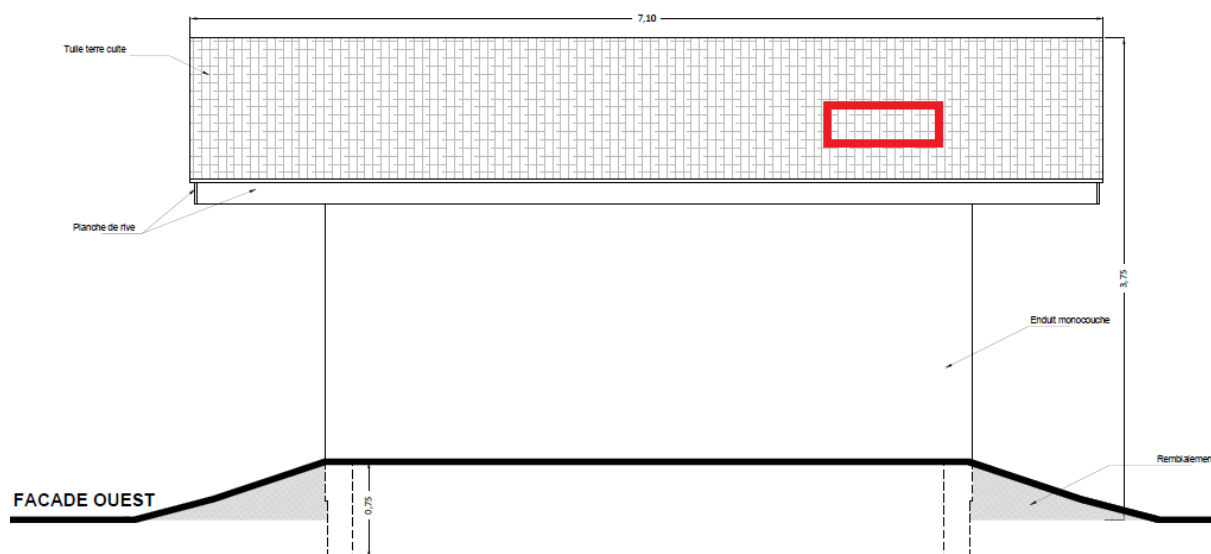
Zone d'implantation du nichoir artificiel sur la façade ouest (emprise rouge)
